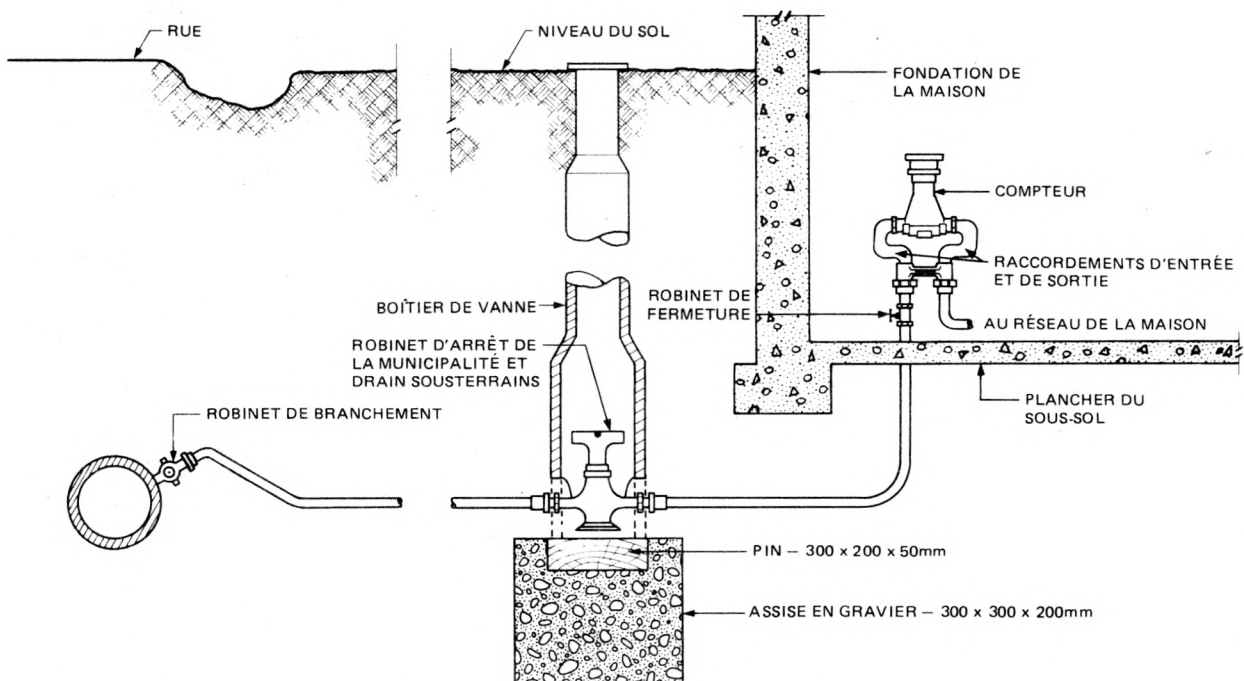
Disposition typique d'un conduite de branchement de compteur et d'une boîte de branchement.
